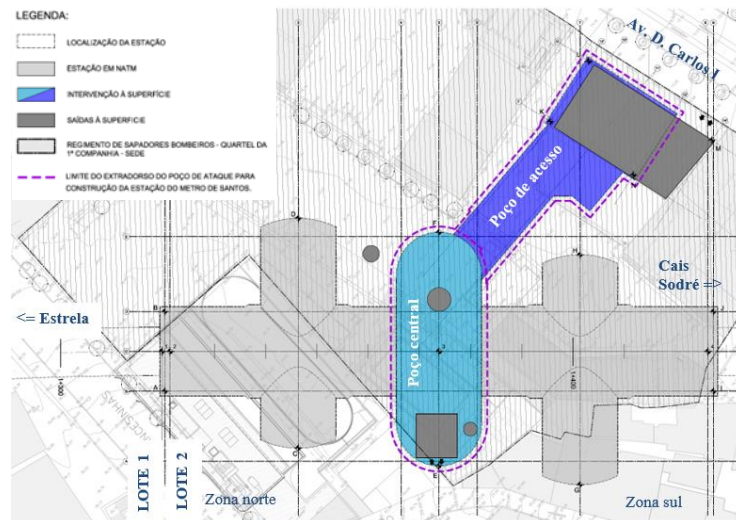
Planta de implantação da Estação Santos e processos construtivos.
